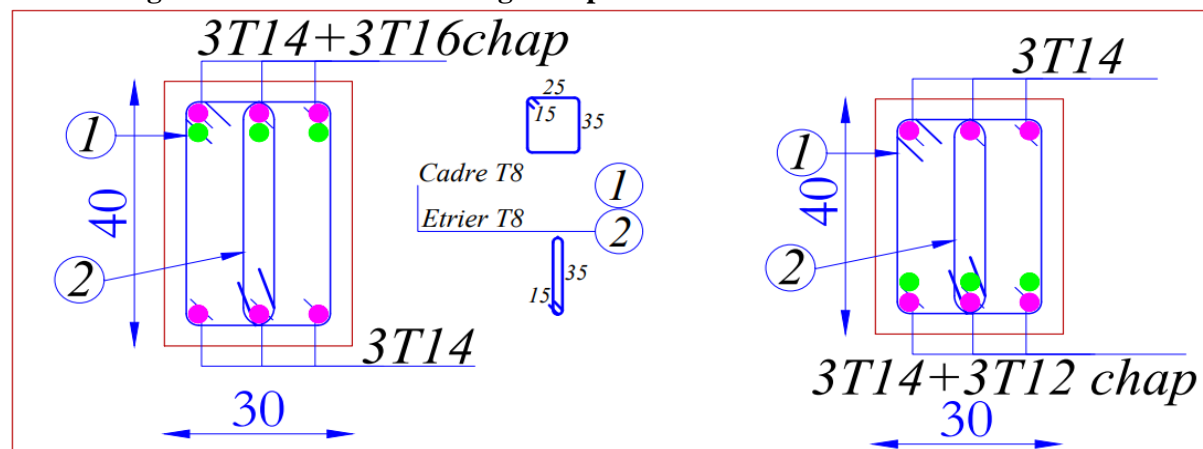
schéma de ferrailage des poutres principales porteuses.
